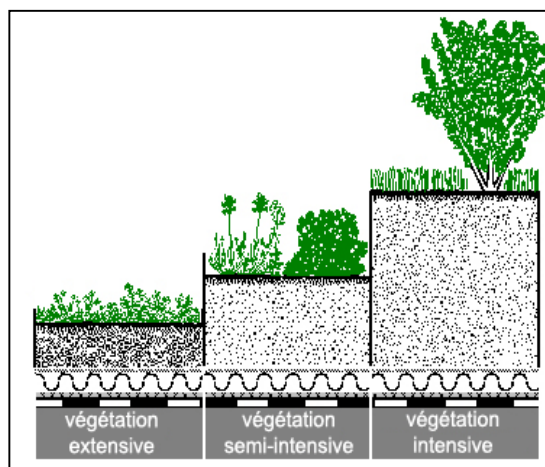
Types de toits végétaux (Lassalle 2006)
